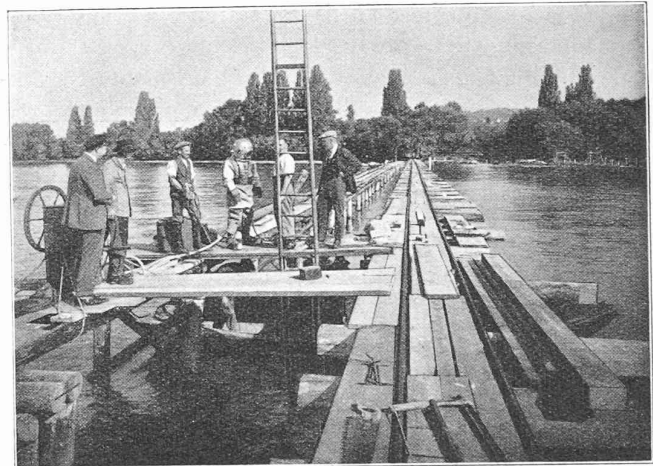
Passerelles de montage de la conduite immergée et fixation par scaphandrier des traverses d'appui de la conduite au droit de la poche de limon.
